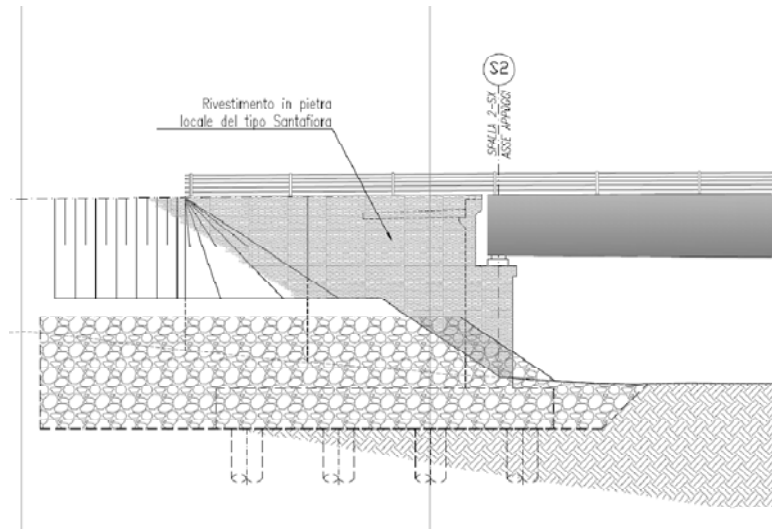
Difesa rilevato e spalla S2 viadotto Merse
